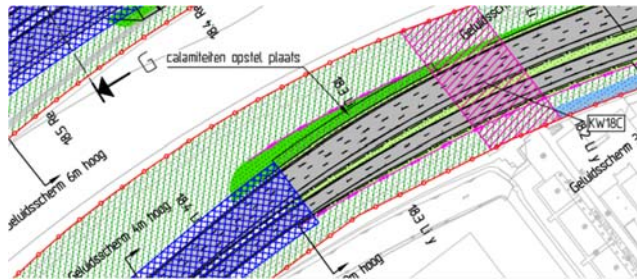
Situatie wTB Zuidelijke tunnelbuis ZW
